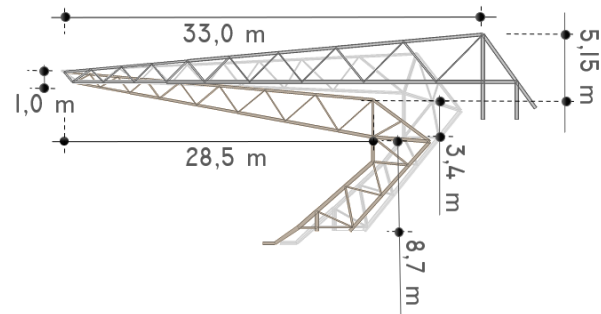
Superposición de cercha de cubierta de zonas este/norte/oeste con cercha de cubierta de zona sur
